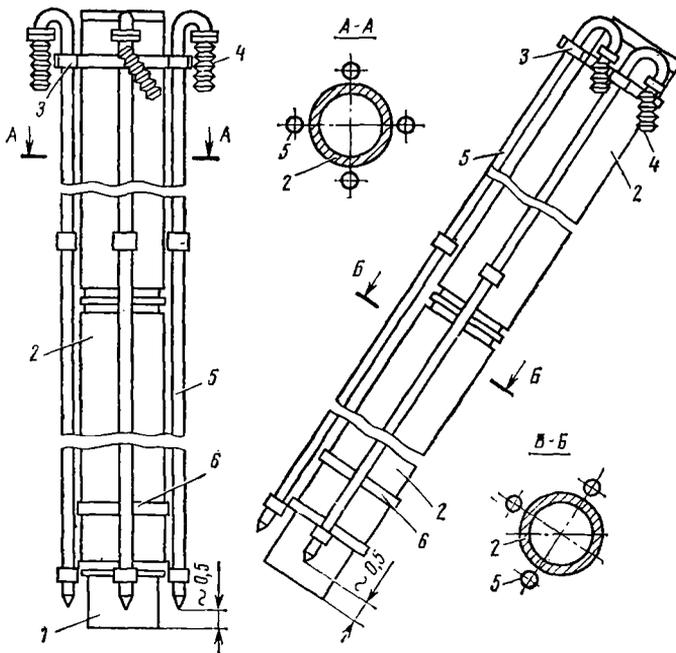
Расположение и крепление водмывных труб к вертикальной и наклонной оболочкам:
